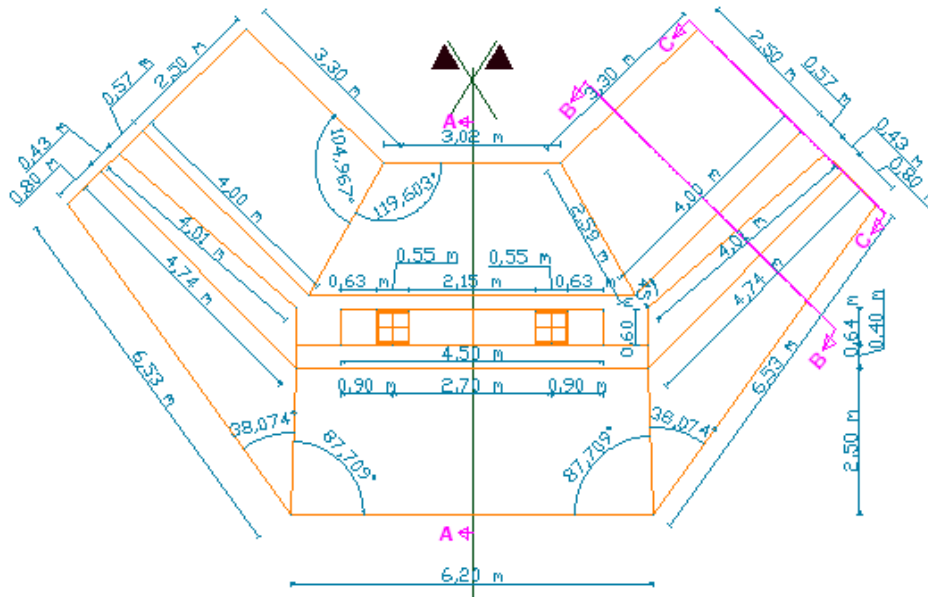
Vista en planta del estribo tipo.
